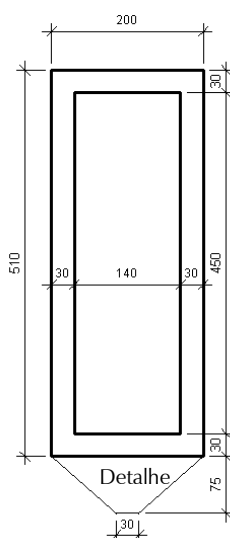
Vista em planta do Aqueduto Xingozinho
